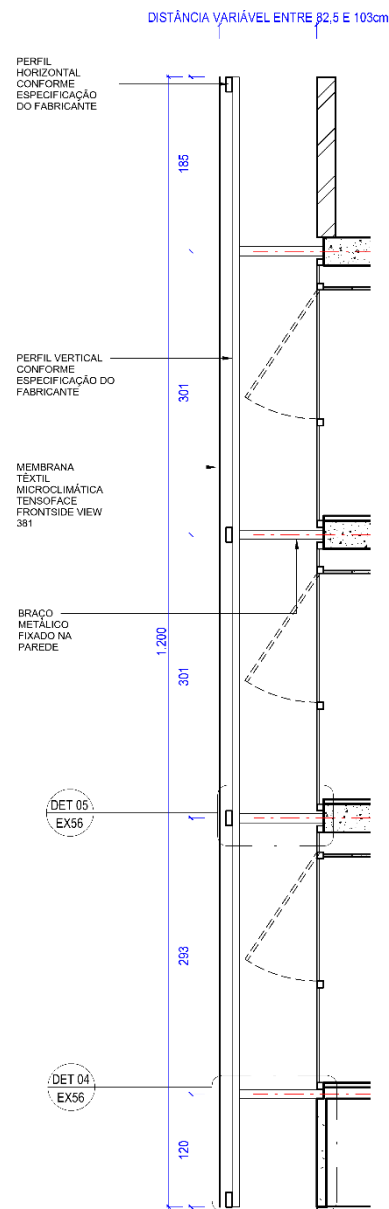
Seção Típica da Fachada 1º ao 3º Pavimento
